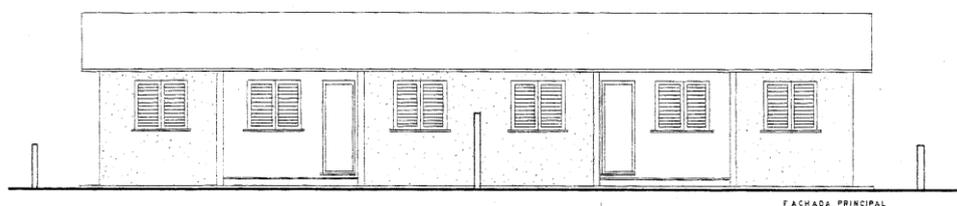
Fachada principal casa tipo B. (Fonte: Cohab)
